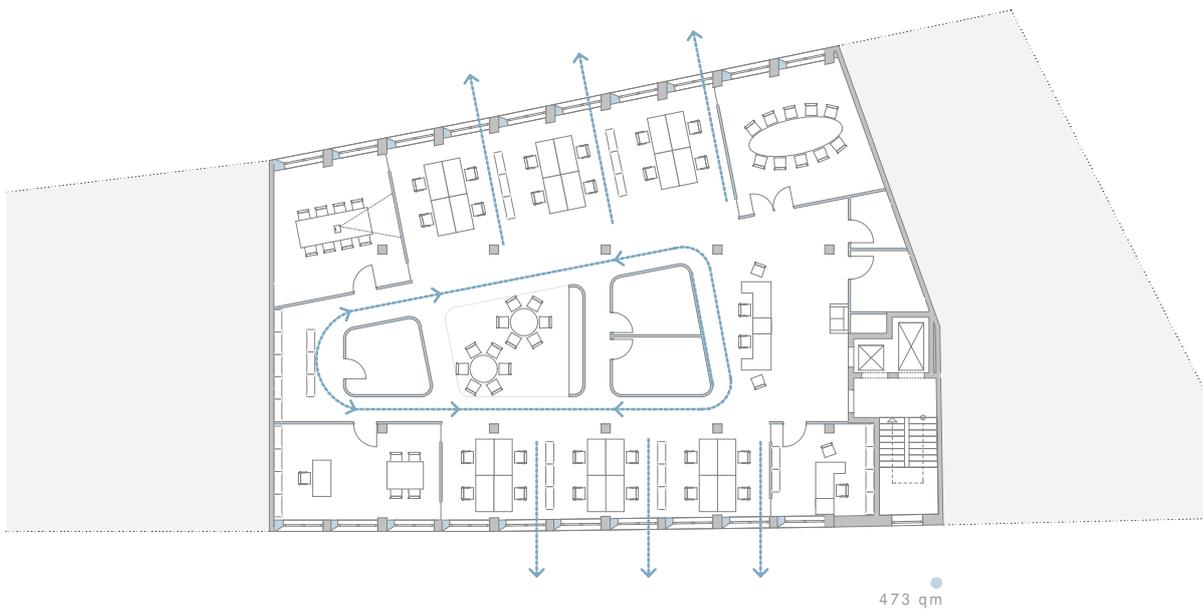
Grundriss Umbau - Grundrissaufteilung
